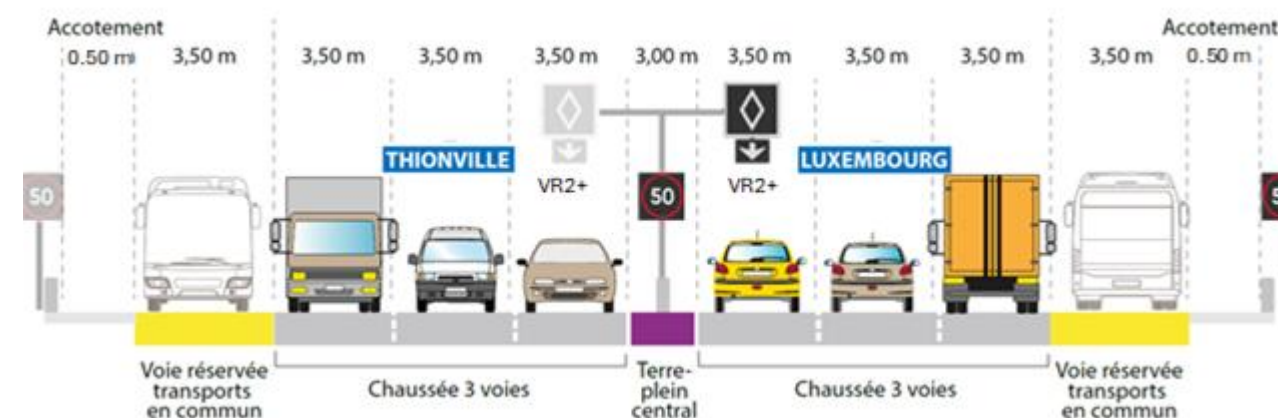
Profil en travers schématique d'une section autoroutière comprenant une voie de covoiturage
